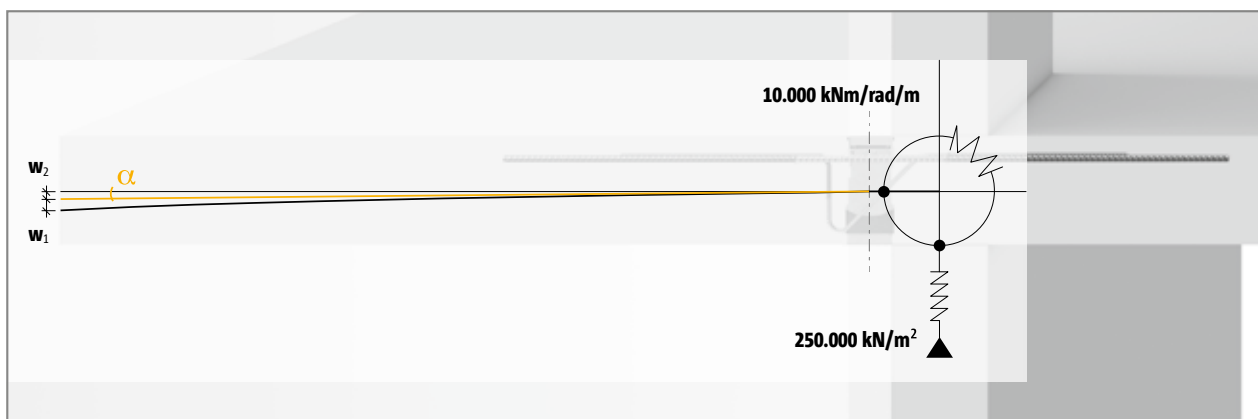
Deformazione di una soletta di balcone con Schöck Isokorb®
